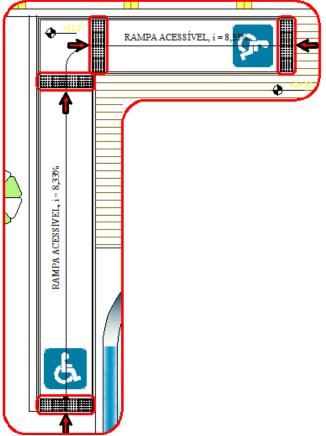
Planta Baixa - Pavimento de cobertura (1)
